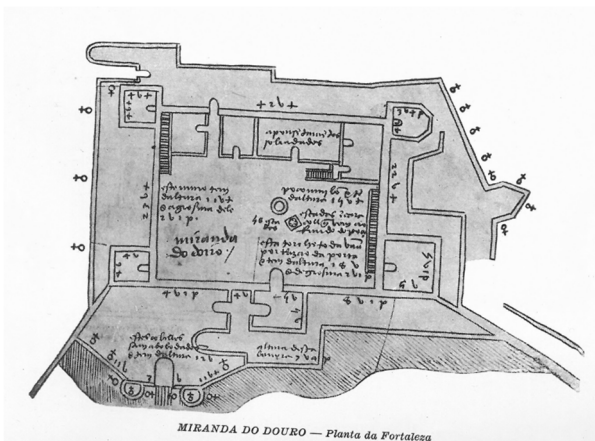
Planta do castelo de Miranda do Douro desenhado pelo Duarte de Armas.
